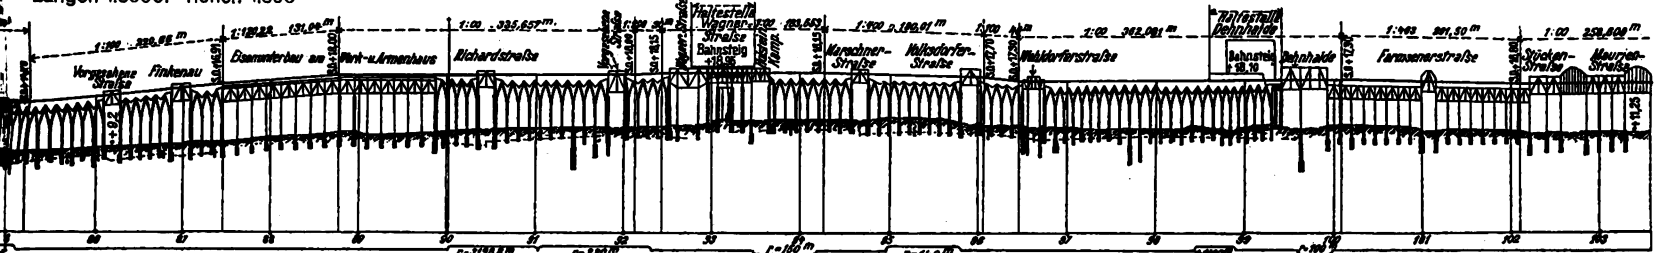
Längenschnitt der Strecke Maurienstraße-Sierichstraße.
